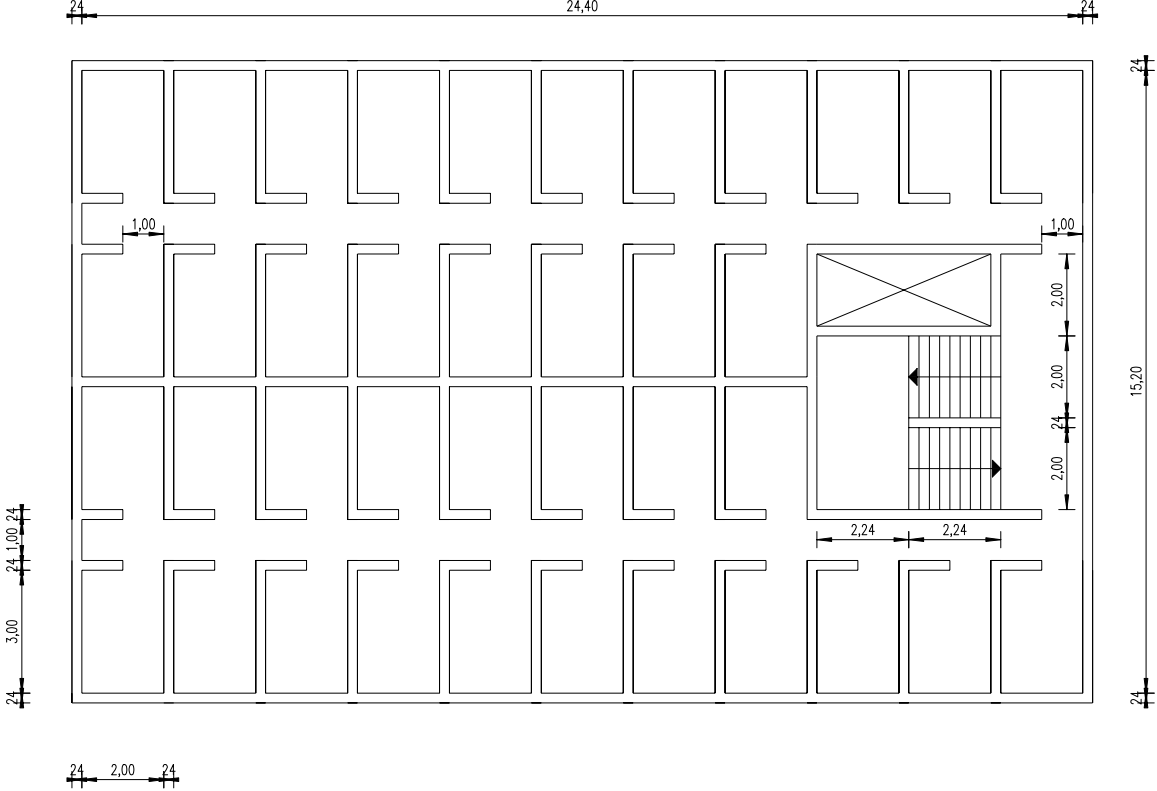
Grundriss des 1. und 2.Obergeschosses
